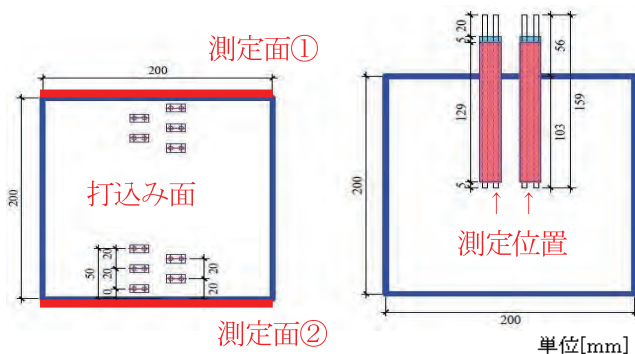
試験体の概要とセンサーの埋設状況（左：上面図 右：断面図）¹⁶⁾
